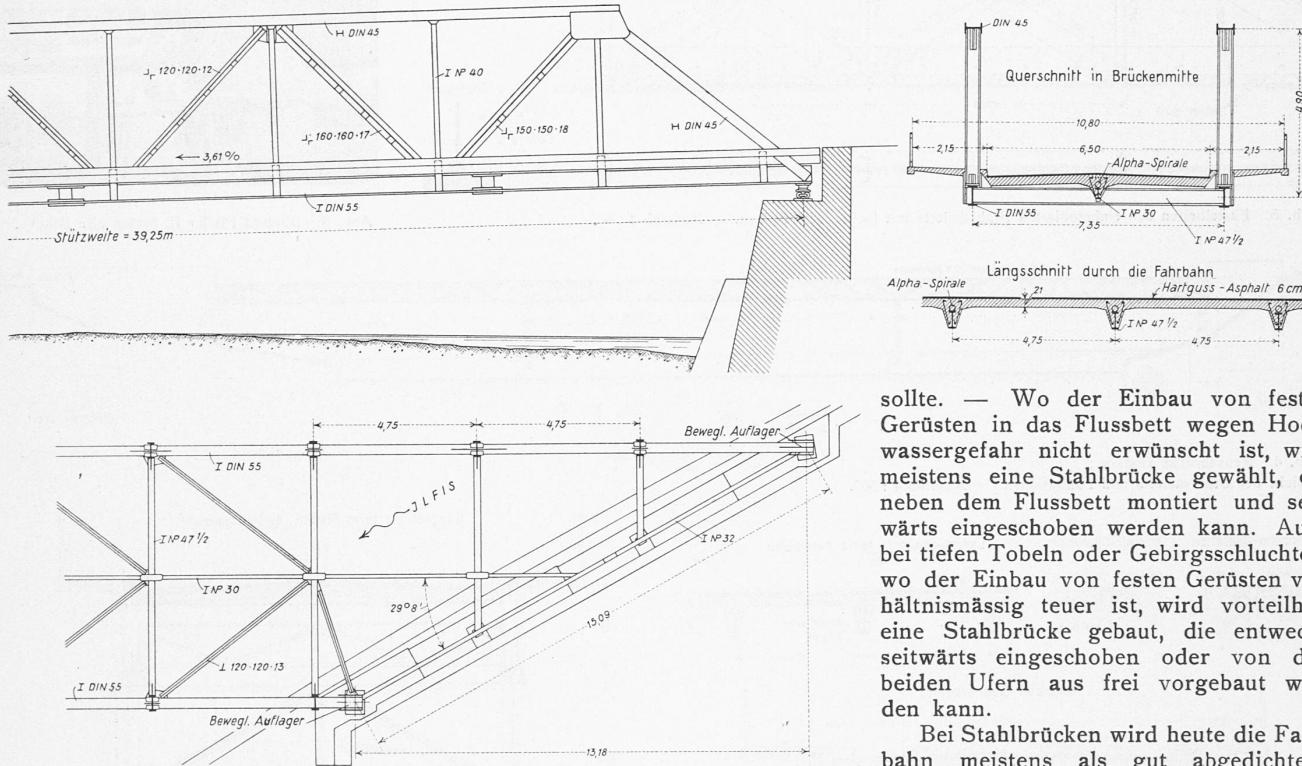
Grundriss, Ansicht und Schnitte der Strassenbrücke über die Ilfis. — Maßstab 1 : 200.
